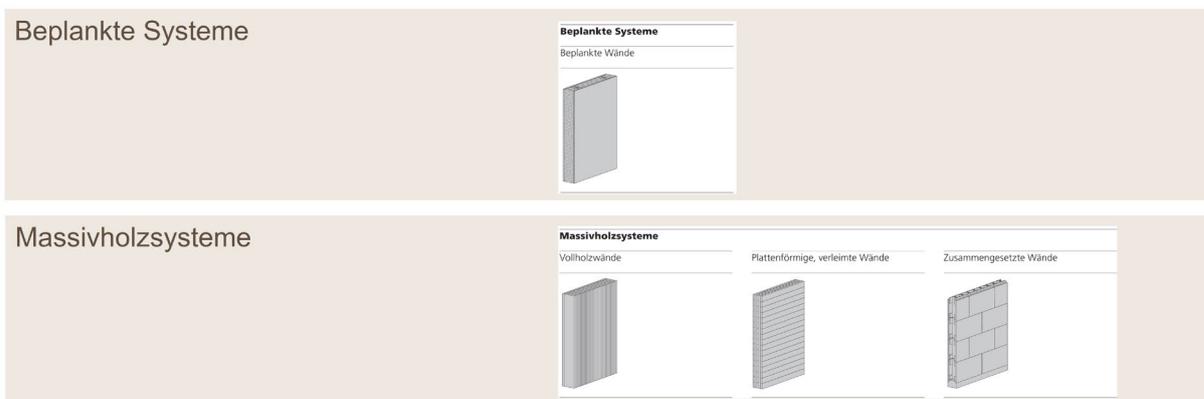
Einordnung Aussenwandkonstruktionen nach Bauteilsystemen [2]
